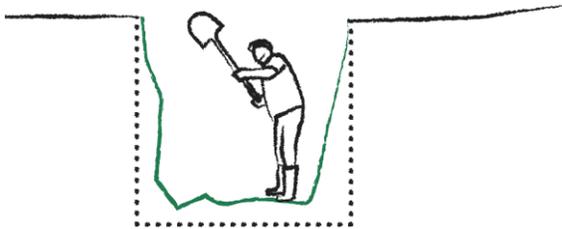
Excavación de fosa para tanques de almacenamiento subterráneo. Fuente: elaboración propia.
